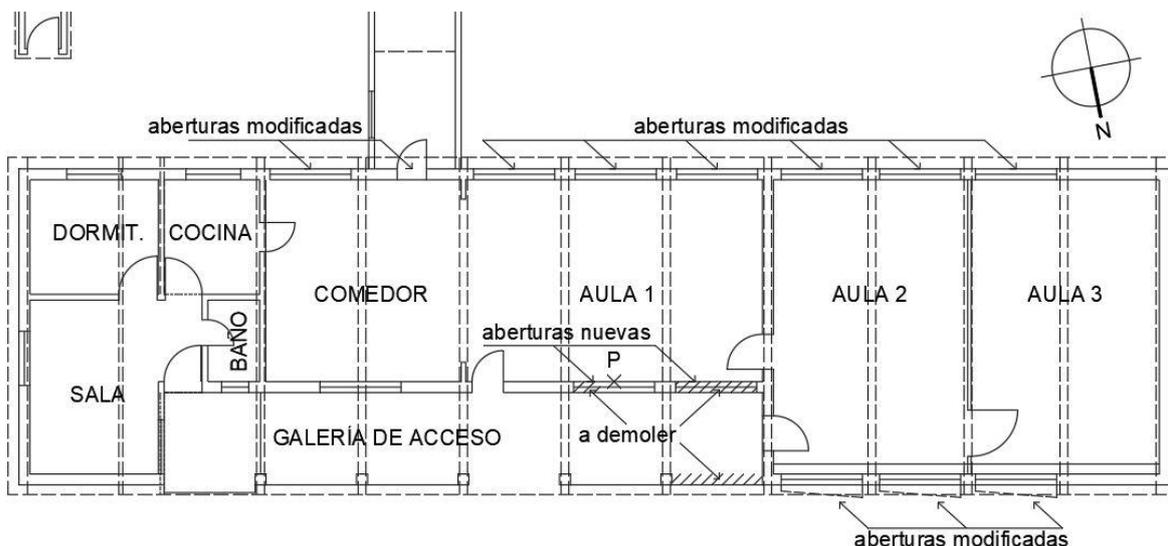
Planta esquemática con aberturas modificadas Escuela 30.
